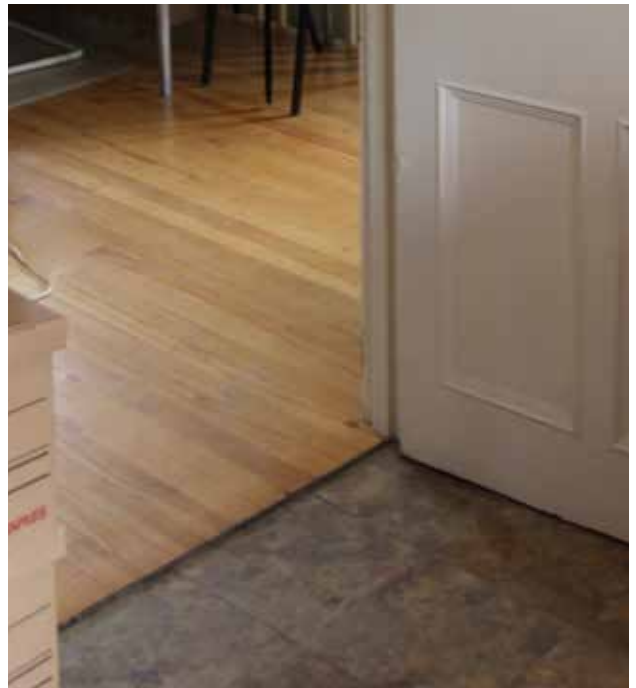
Dans la cuisine d'été, où se situent les espaces administratifs de la Fondation François-Lamy, le plancher est partiellement en bois.
